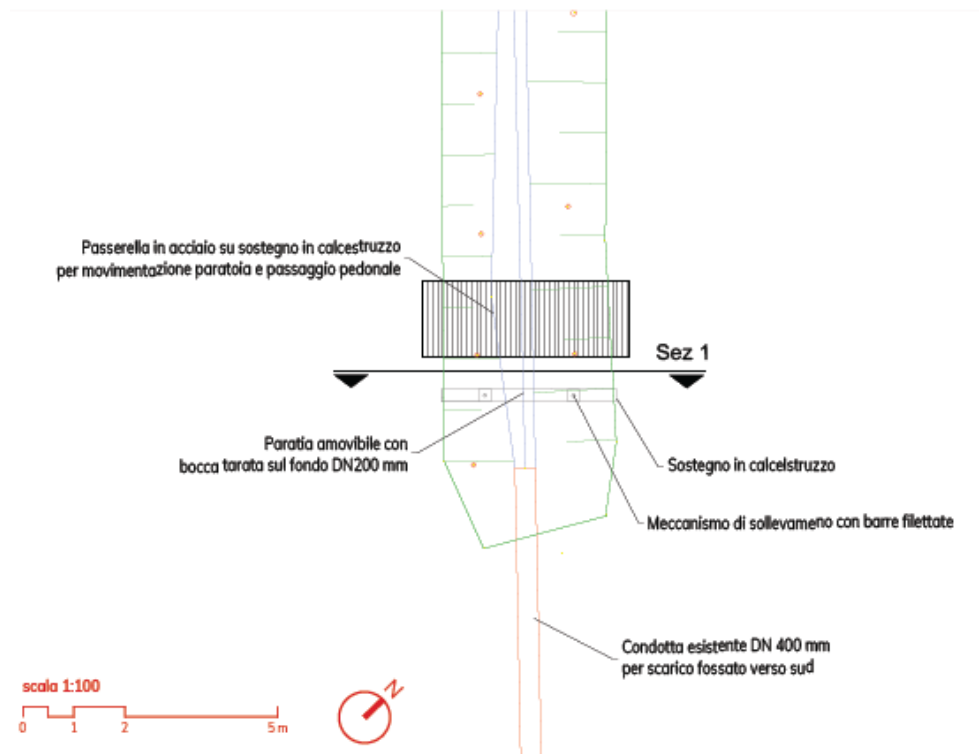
Planimetria di dettaglio su manufatto di regolazione
